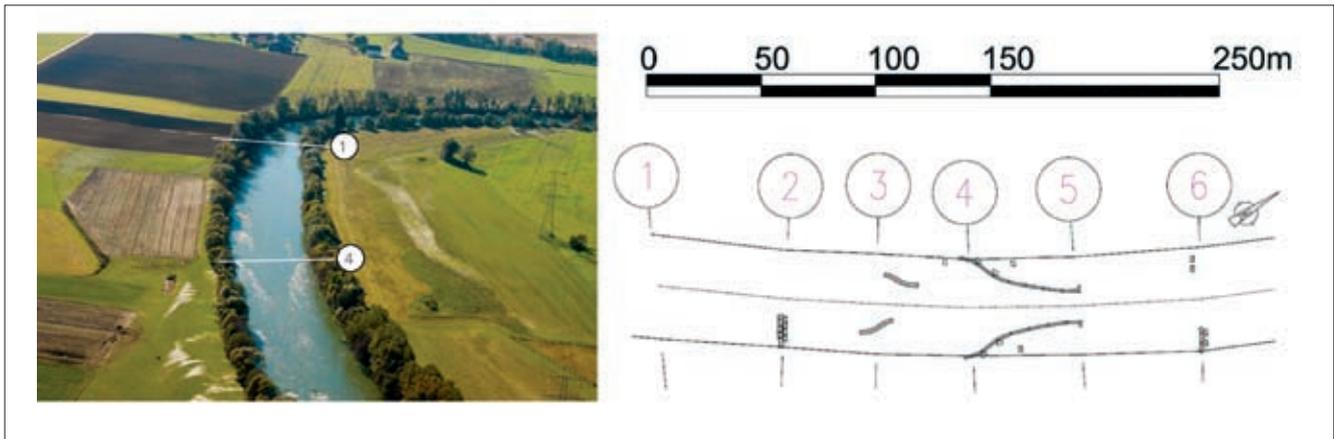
Mur-Strömungstrichter: Luftbild (© Bildhauer Graz) und Grundriss-Plan
